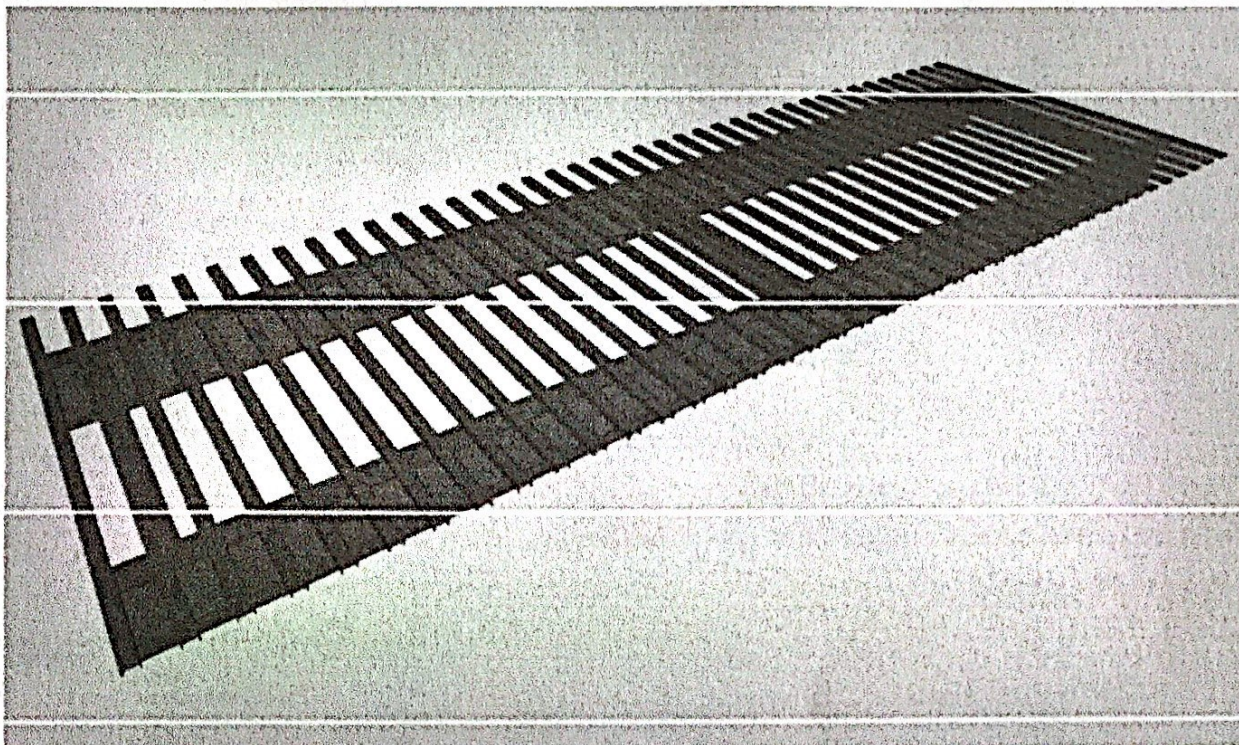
Vista simplificada da estrutura metálica sem chapa da pista de rolamento
